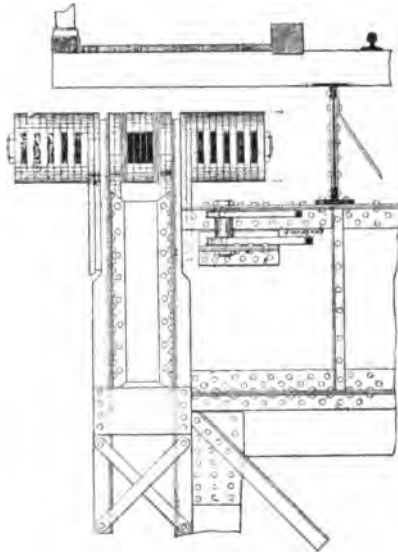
Contreventement non placé dans le Plan des Semelles.
